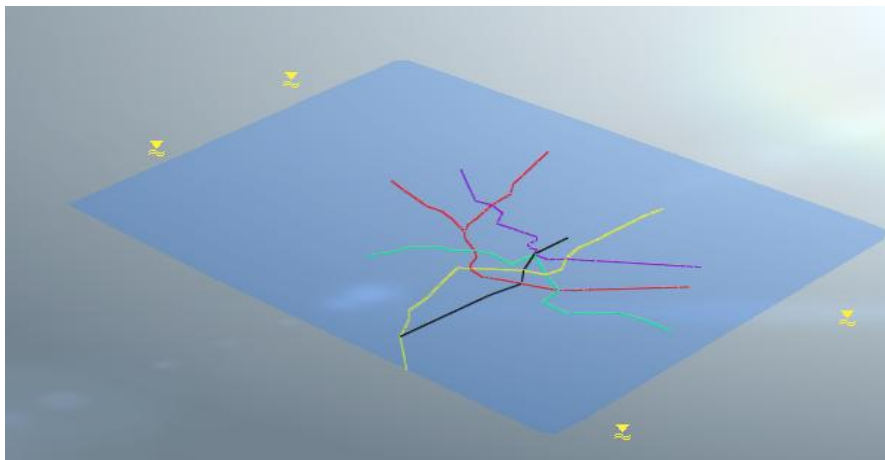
Tracciato planimetrico delle linee metropolitana e modellazione falda
